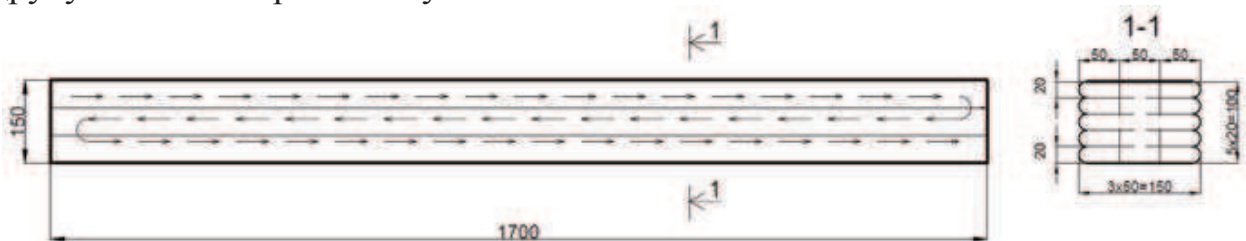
Схема руху сопла 3D принтера при формуванні балки
